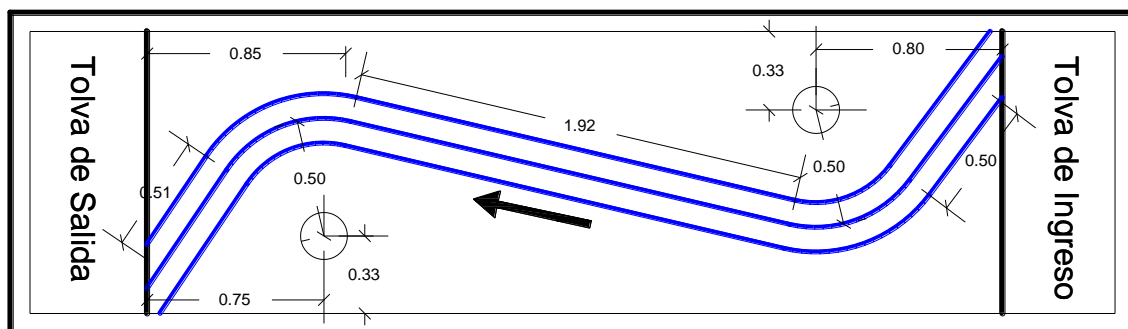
Configuración en planta. Sección inicial. Geometría 2
